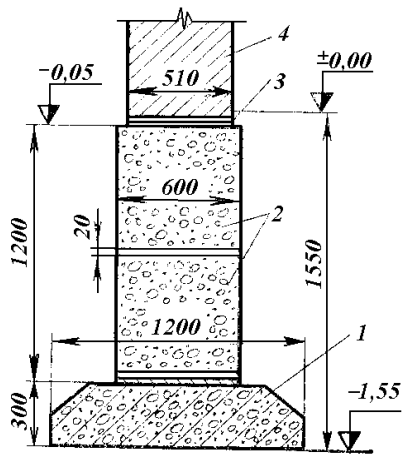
Стрічковий фундамент з прямокутних блоків із залізобетонною подушкою для несучих стін:
